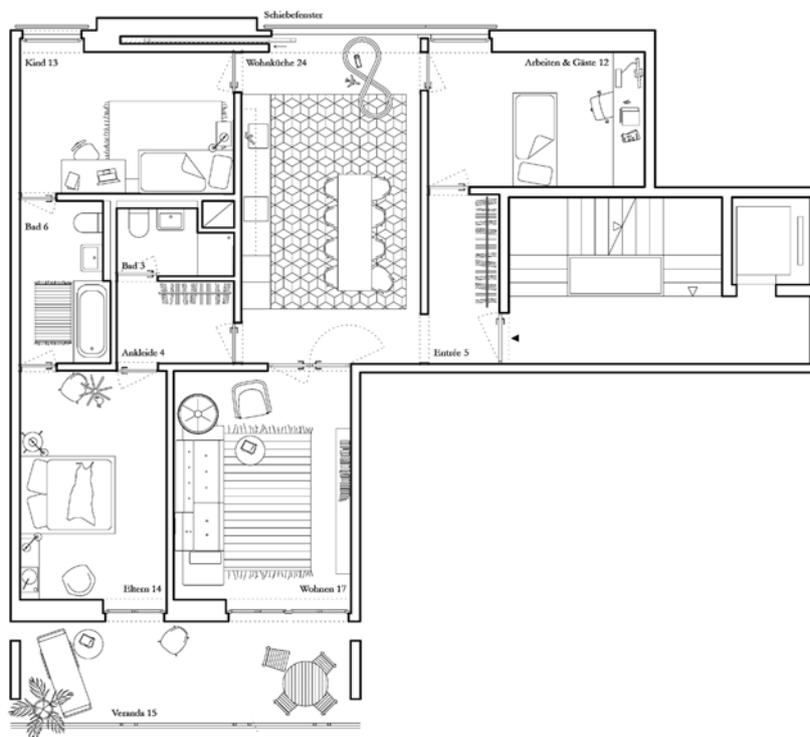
Wohnungsgrundriss 4.5 Zimmer - Whg.
